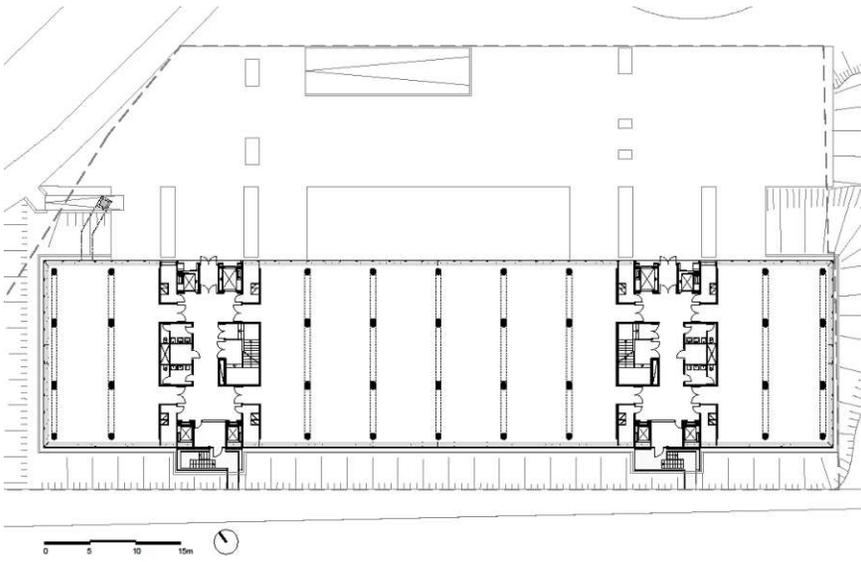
Grundriss, Hôtel Industriel Berlier
